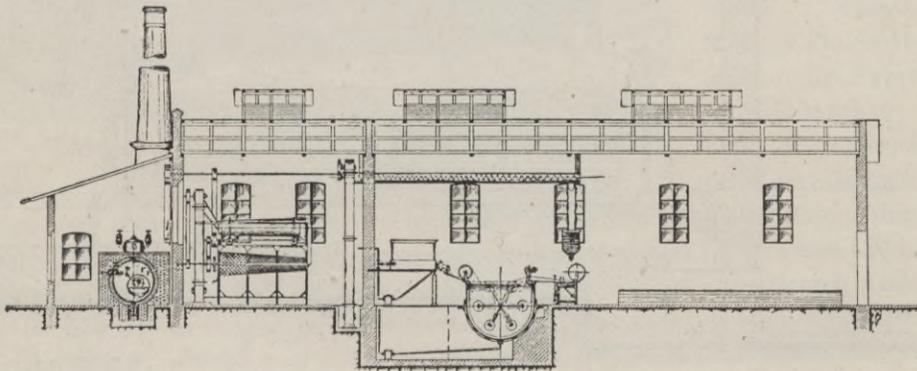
Dachpappenfabrikanlage für Dampfheizung und Kraftbetrieb. (Maschinenfabrik Calbe a. S. G. m. b. H.)
